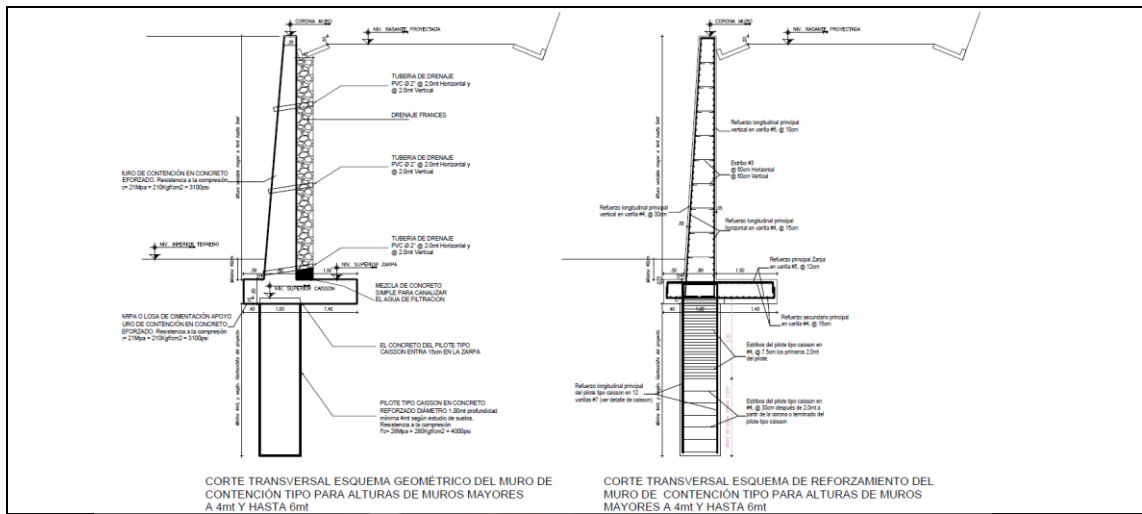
Detalle de los pilotes para muros de 4 a 6 metros de altura.
